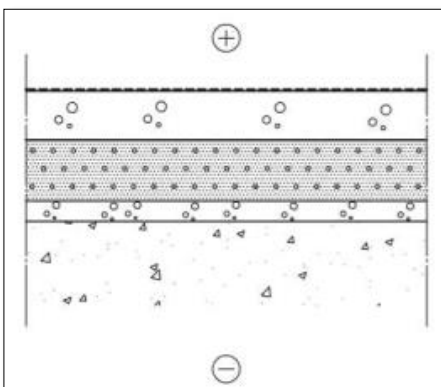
Rakenneavauksesta RA2 todennettu alapohjarakenne sisältä ulospäin: 32 mm:n ponttilauta, puurunko ja mineraalivillaeristekerros, pikisively ja betonilaatta.
